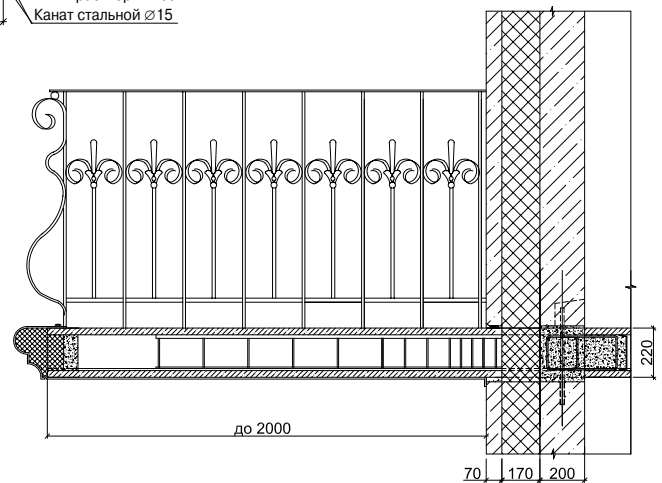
Пример выполнения балкона с трехслойной панелью на наружной стене
